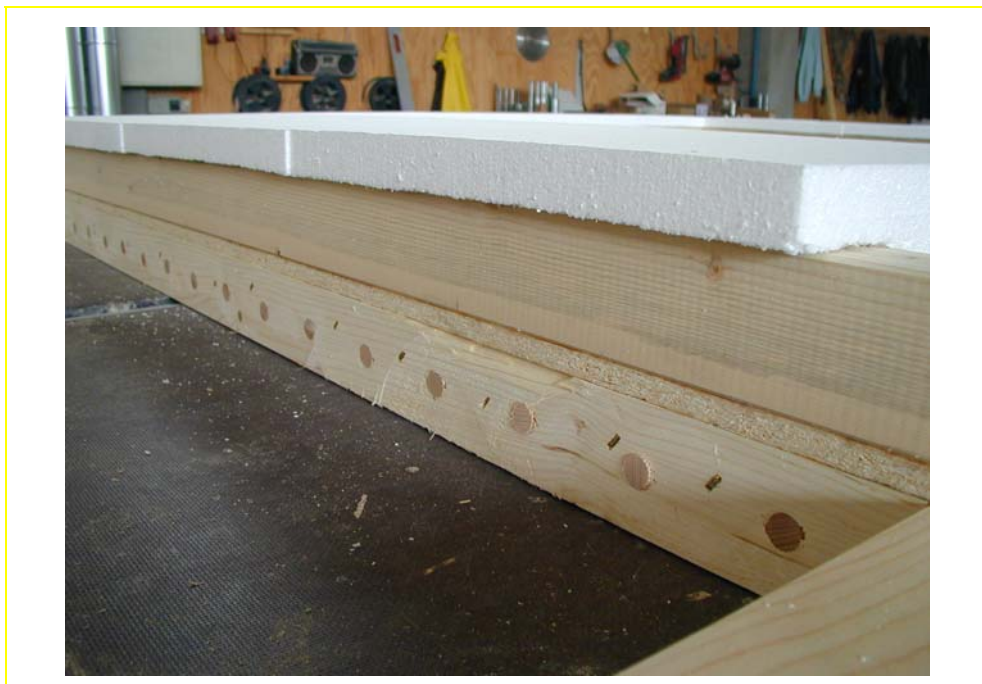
Brettstapelelement mit werkseitig aufgebrachter Dämmung
